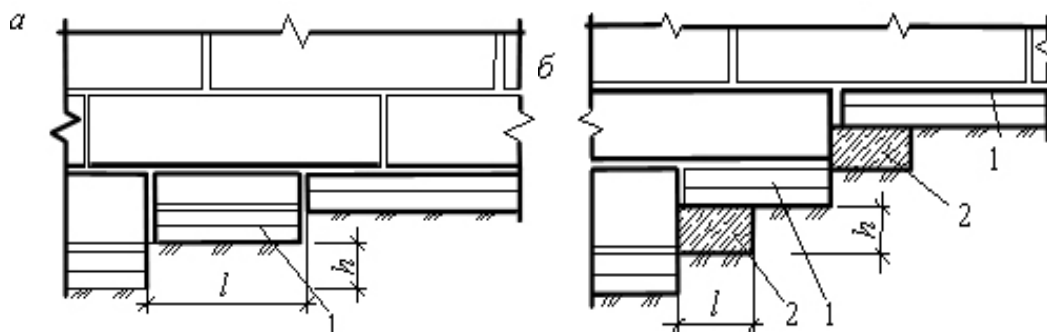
Перехід фундаменту від однієї позначки закладання до іншої: а – збірних; б – із використанням монолітного бетону; 1 – фундаментні плити; 2 – бетон за місцем
